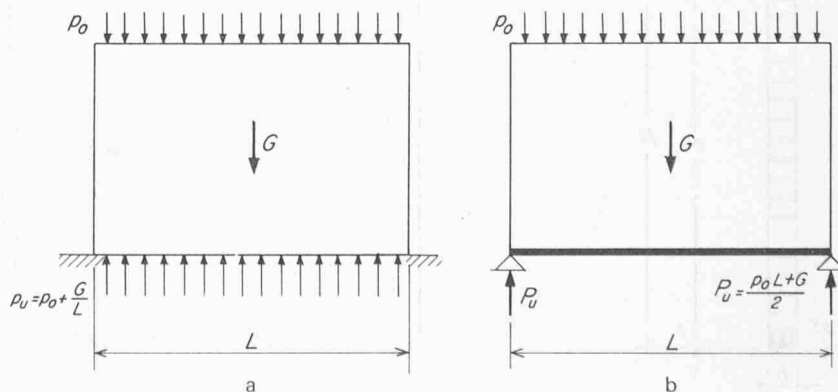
a) Kontinuierliche Lastabtragung einer Tragwand; b) Konzentrierte Lastabtragung einer selbsttragenden Wand mit Zuggurt am unteren Rand
